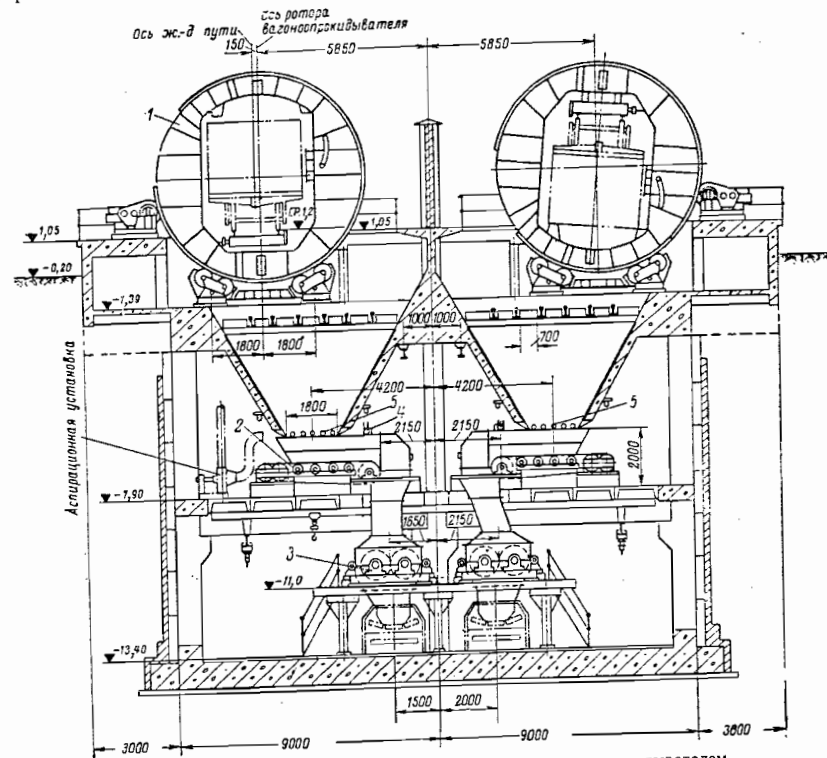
Разгрузочное устройство с роторным вагоноопрокидывателем.
